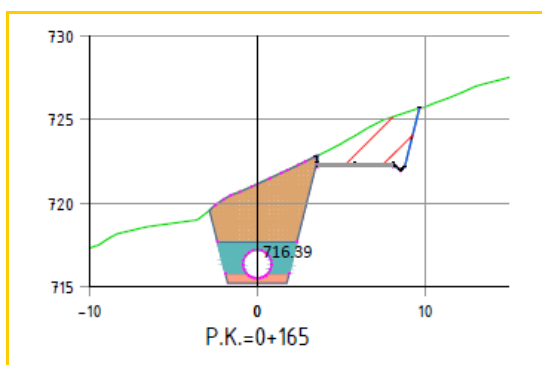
Sección transversal con la excavación máxima a realizar entorno al PK 0+165.
